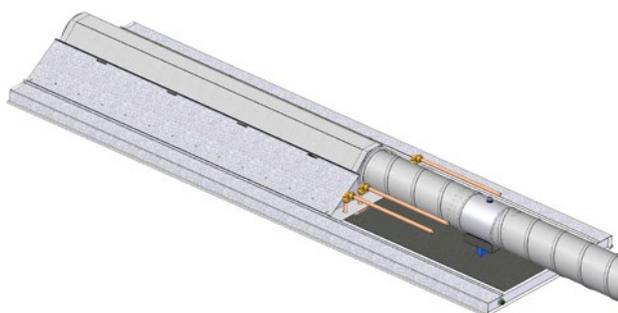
Exemple de raccordement eau et air horizontal et rectiligne.
